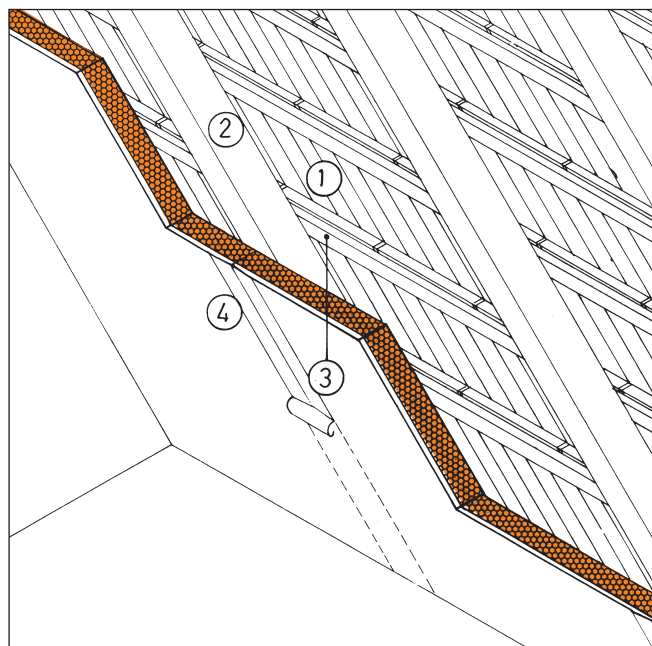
Isolamento di tetto a falde sotto orditura.
